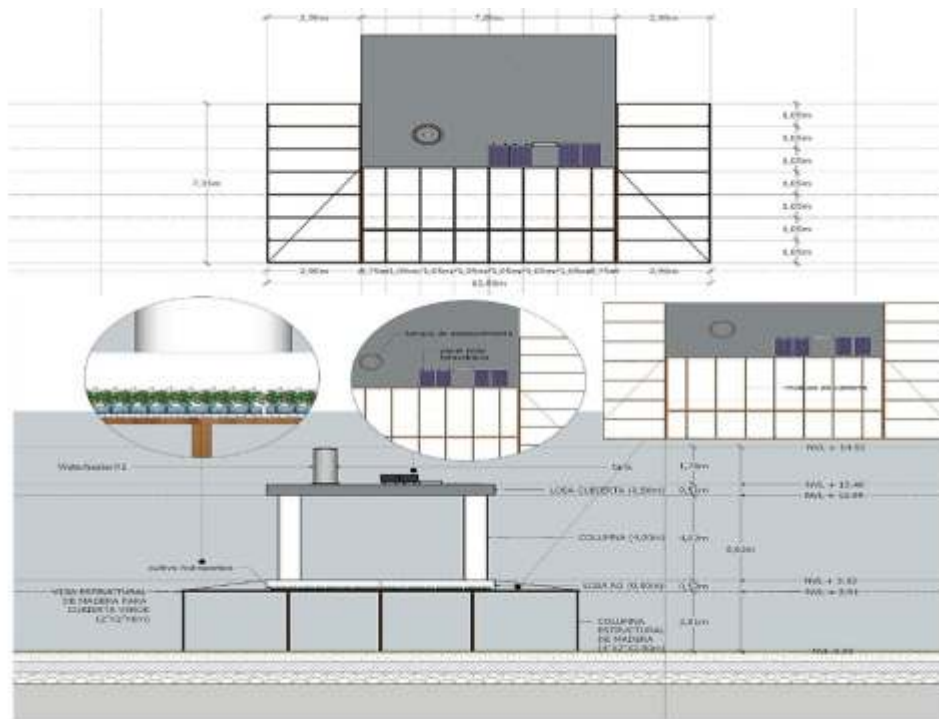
Planta y Corte -sección transversal de diseño de cubierta verde autónoma y sostenible.
